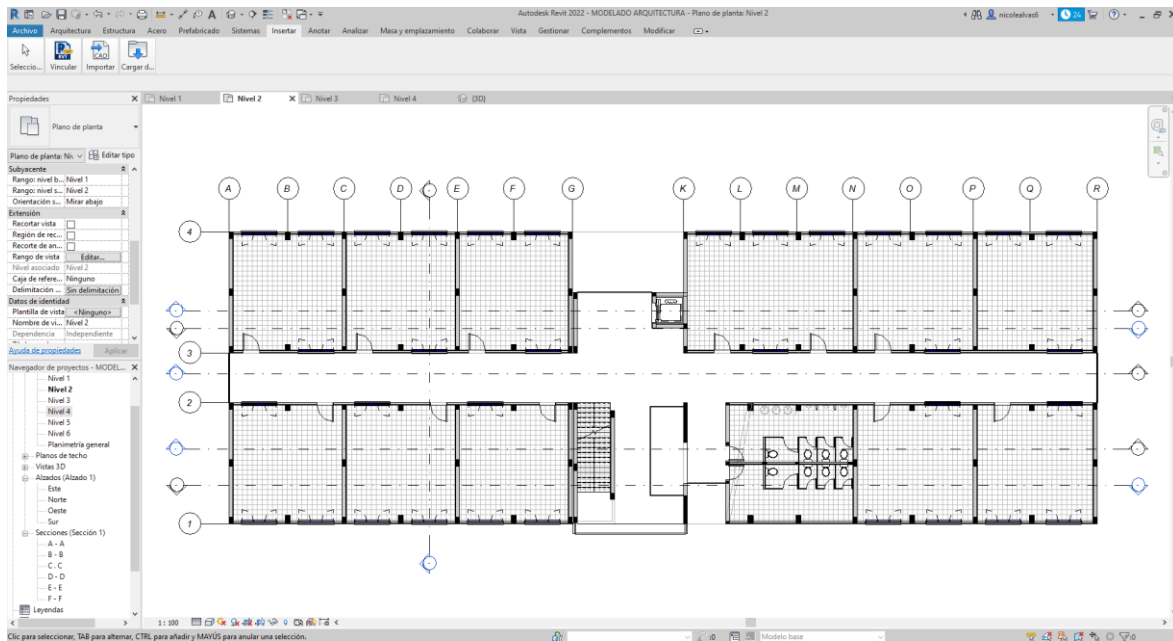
Vista en planta del segundo y tercer nivel – Arquitectura
